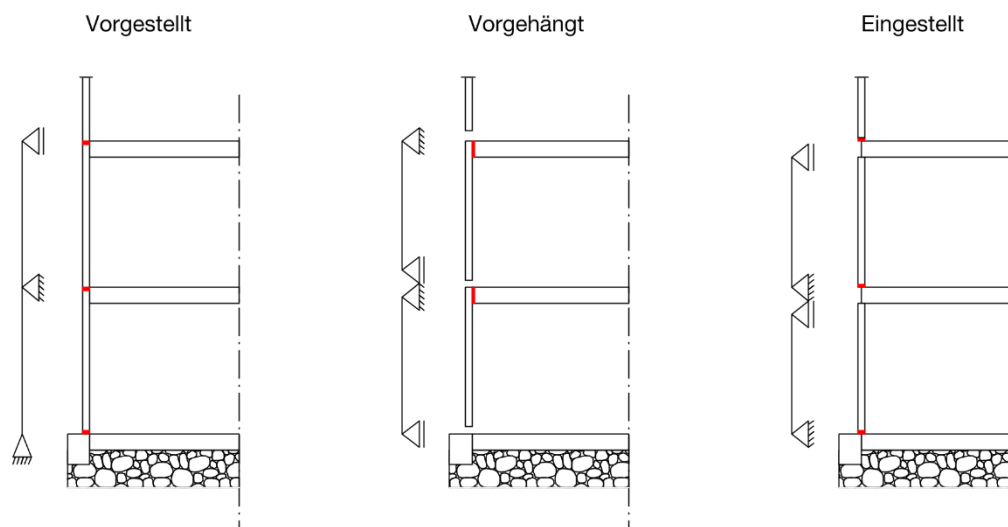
Anschlussvarianten nichttragender Fassadenelemente (Eigene Darstellung)
